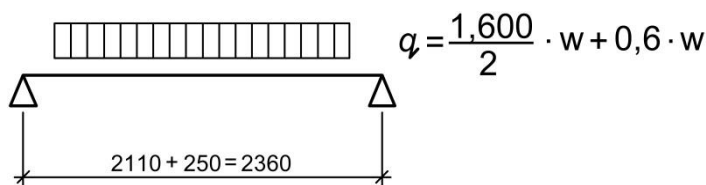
Расчетные схемы по сечениям 1-1, 2-2, 3-3, 4-4
